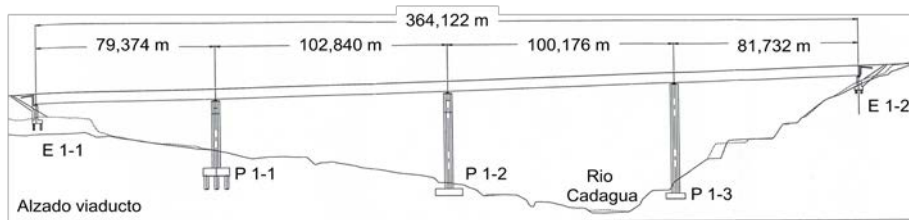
Alzado del viaducto de la Variante Sur Metropolitana de Bilbao.
